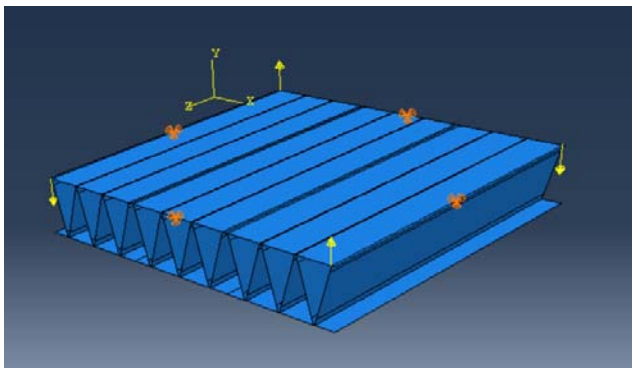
Calcul de la rigidité torsionnelle du platelage
